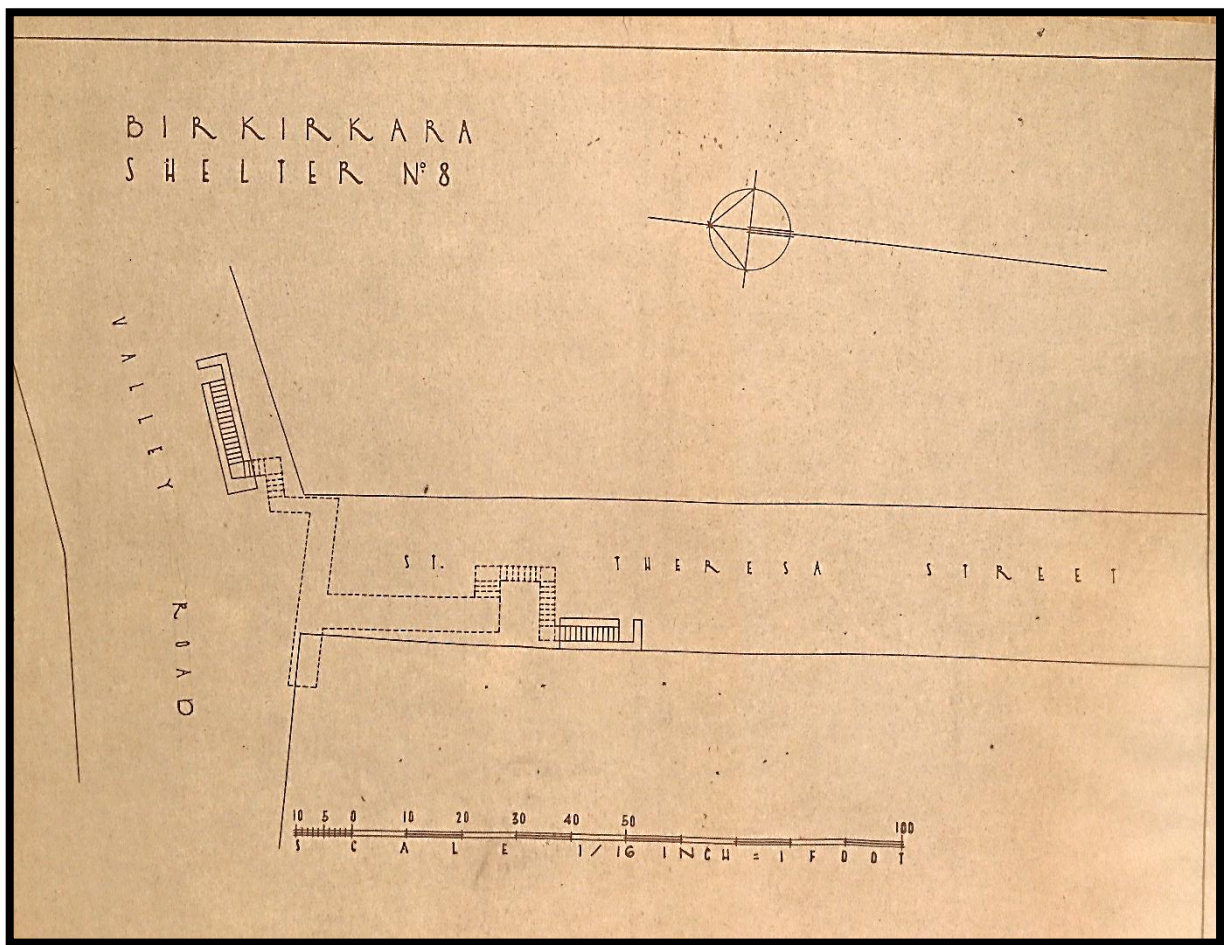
Planta do Abrigo nº8 "Valley Road – St. Theresa Street."
